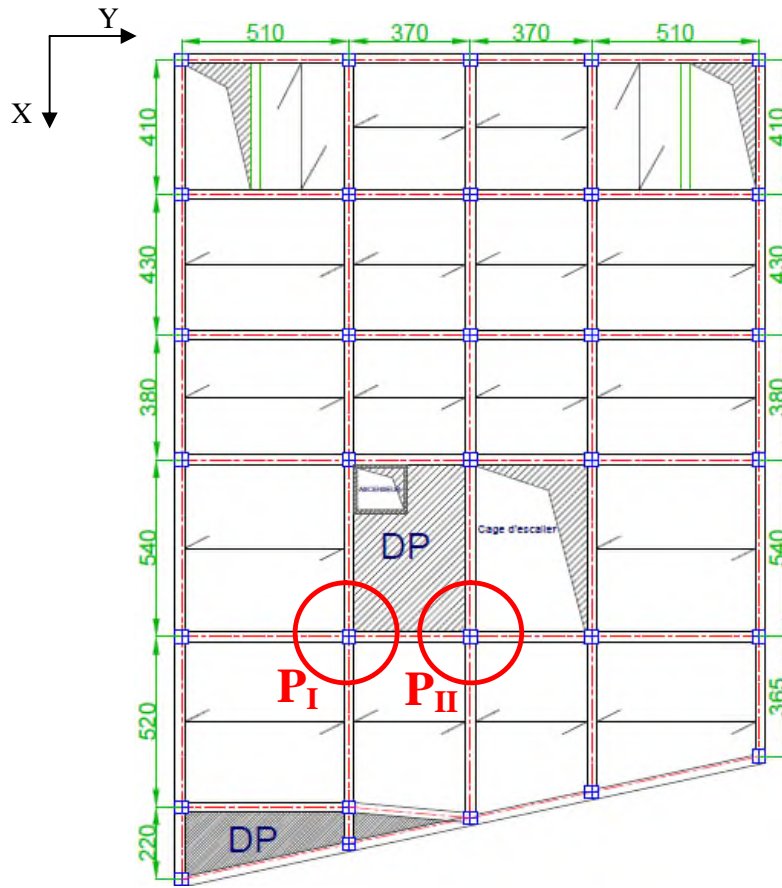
Disposition des poutrelles au niveau du RDC.
